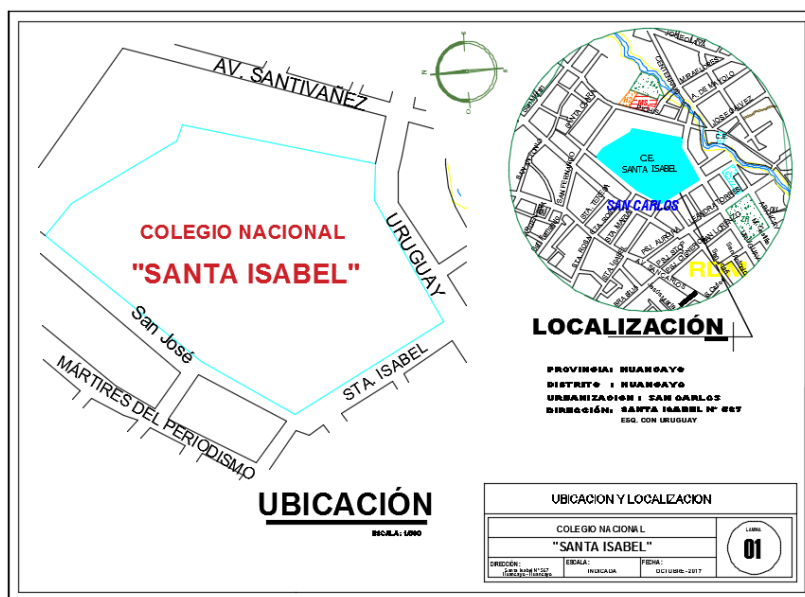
Plano de ubicación Colegio E. Santa Isabel
